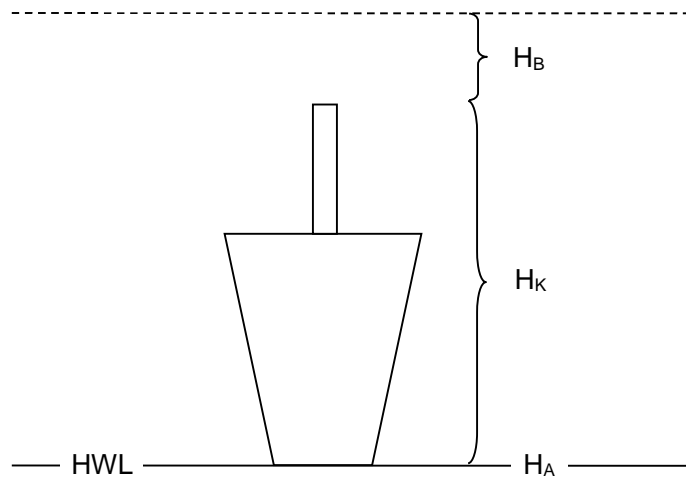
Jarak ruang bebas untuk jalur tidak terdapat gangguan
